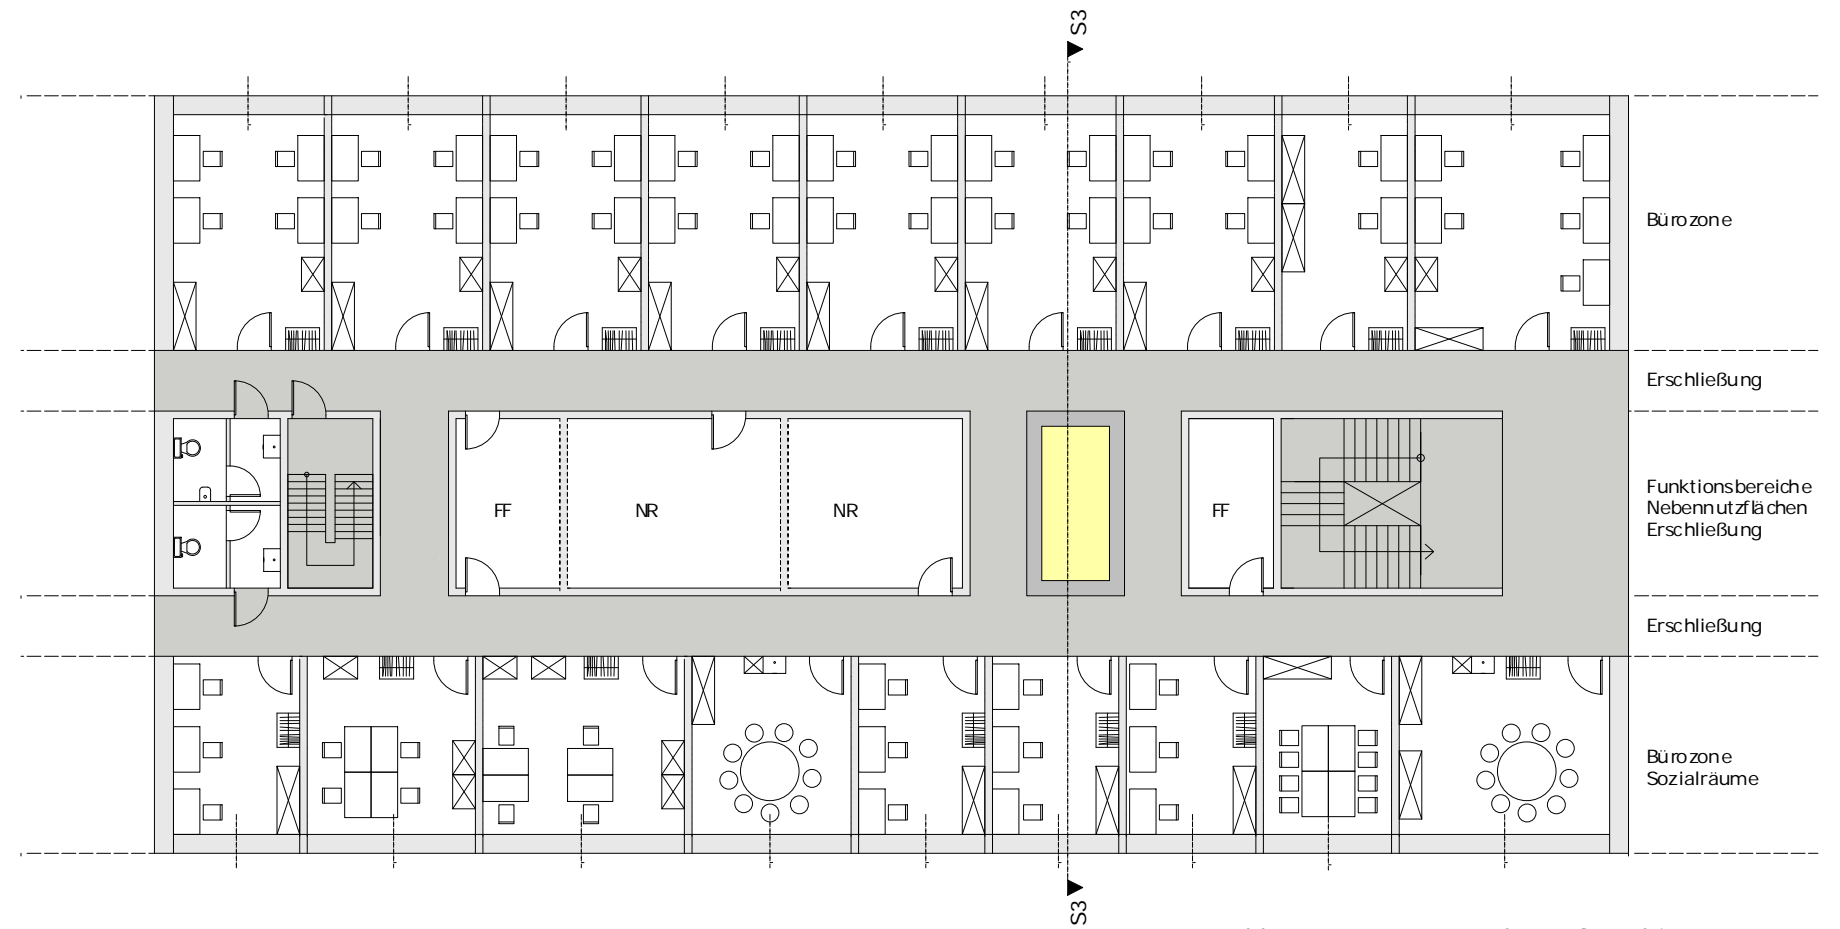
Auszug Verwaltung Grundriss M=1:200
